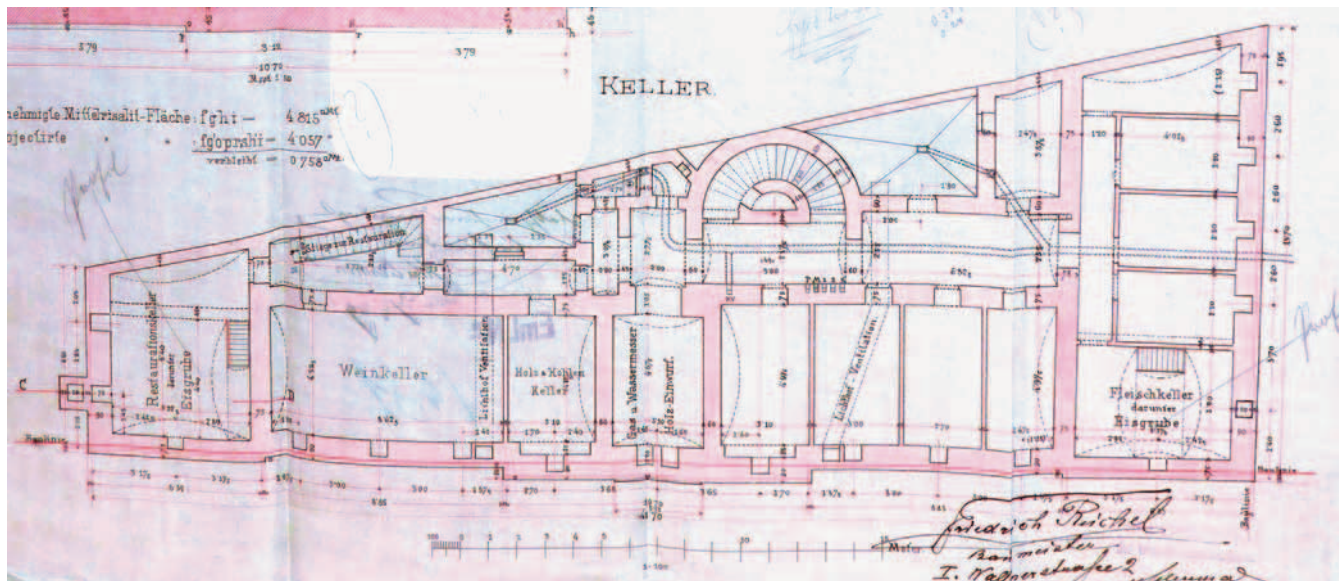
Kellerplan des Hauses Garelligasse 3/Frankgasse 7 vom 27. März 1889. (Plan: MA 37 – Baupolizei, Wien 9, EZ 1481)
